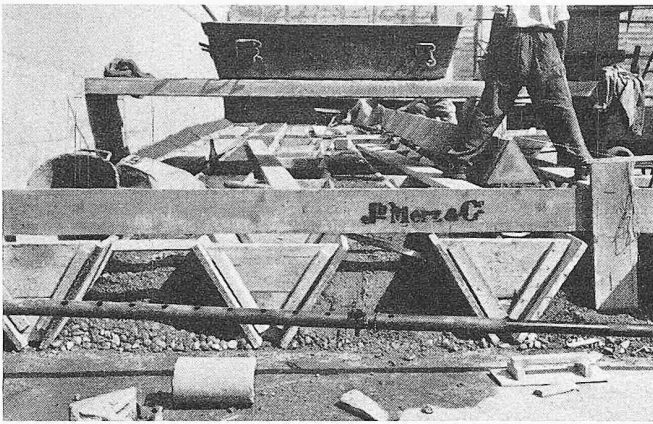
Betonieren der Seitenrinnen; rechts Verlegung der vorfabrizierten Höcker
